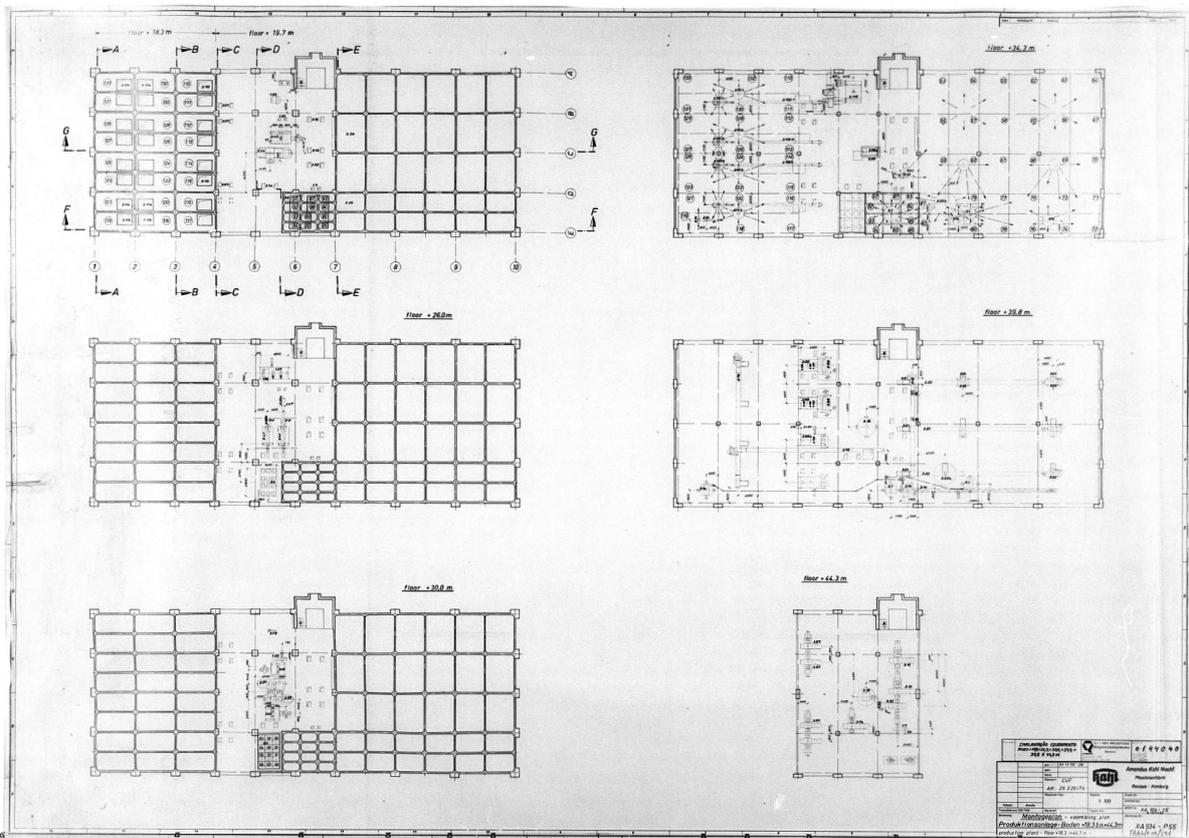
| Plantas de implantação do equipamento da fábrica da Nutasa.
